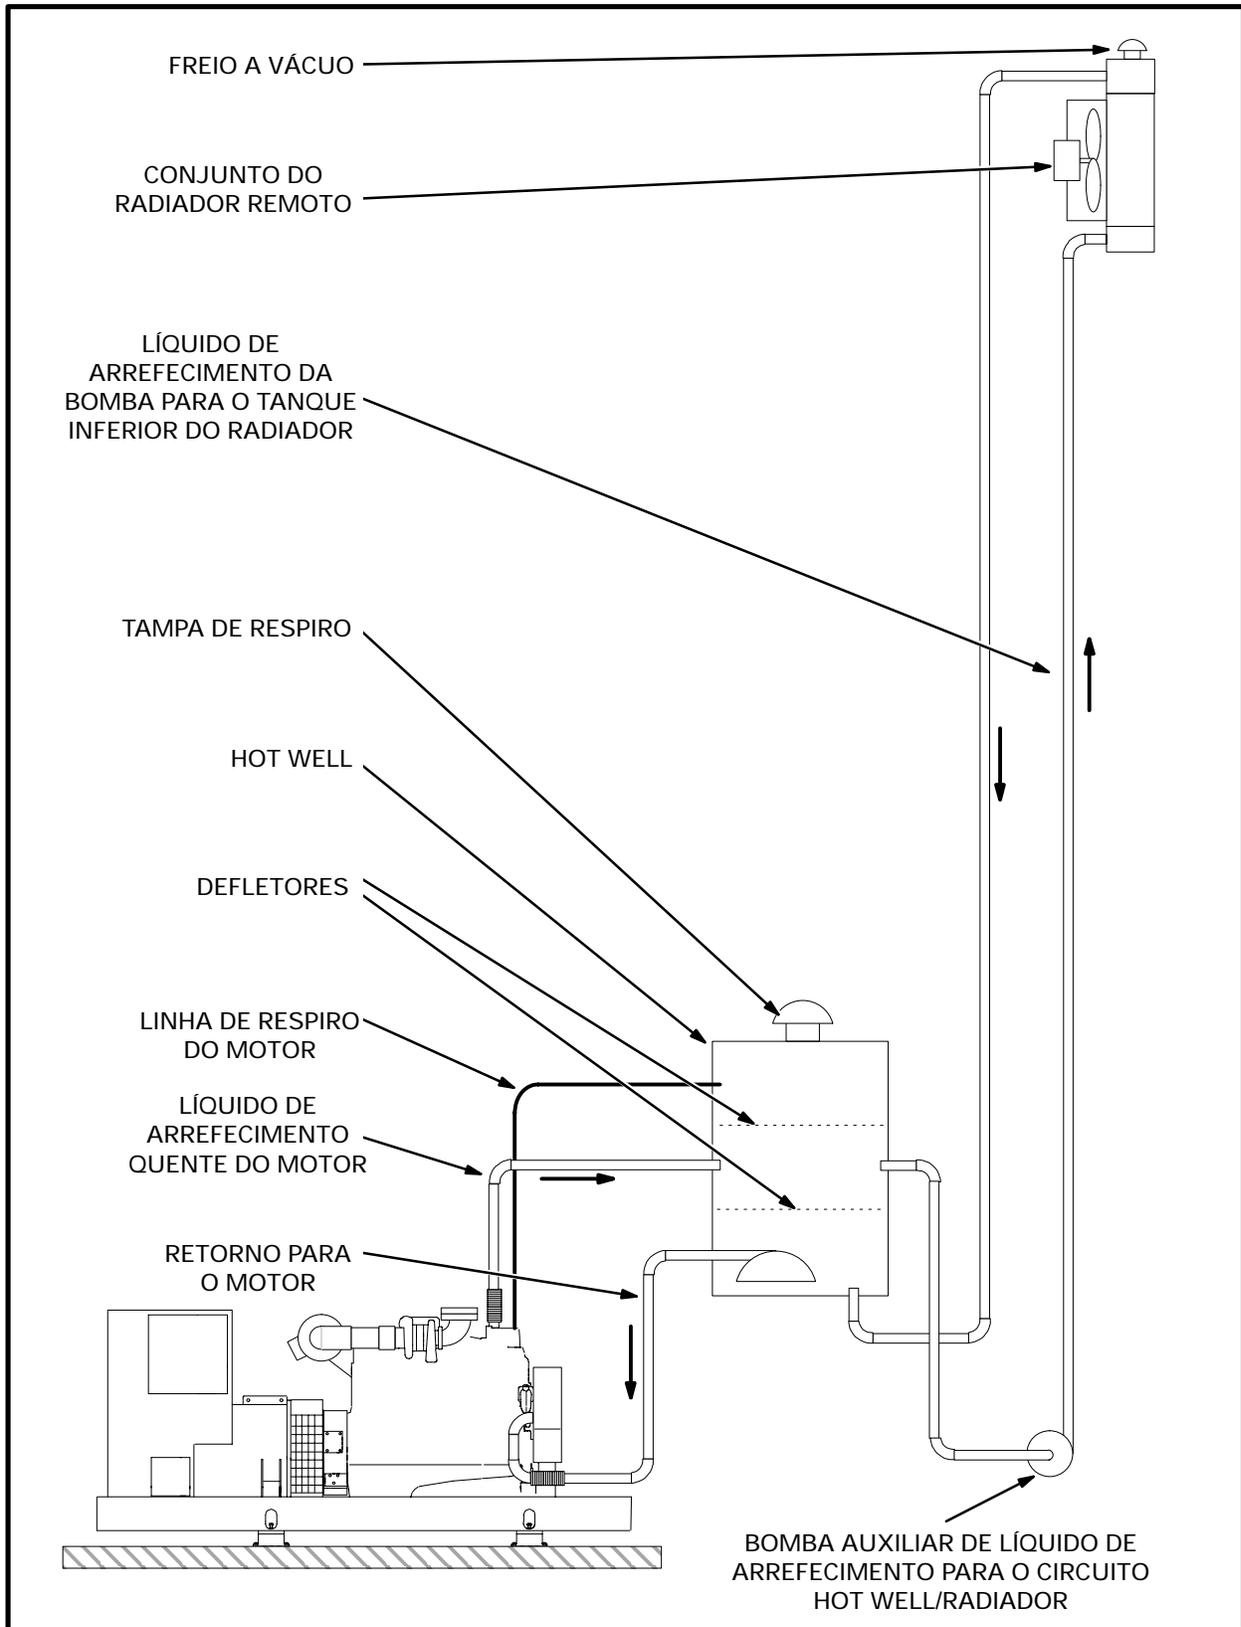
Radiador Remoto com "Hot Well" e Bomba de Arrefecimento Auxiliar
